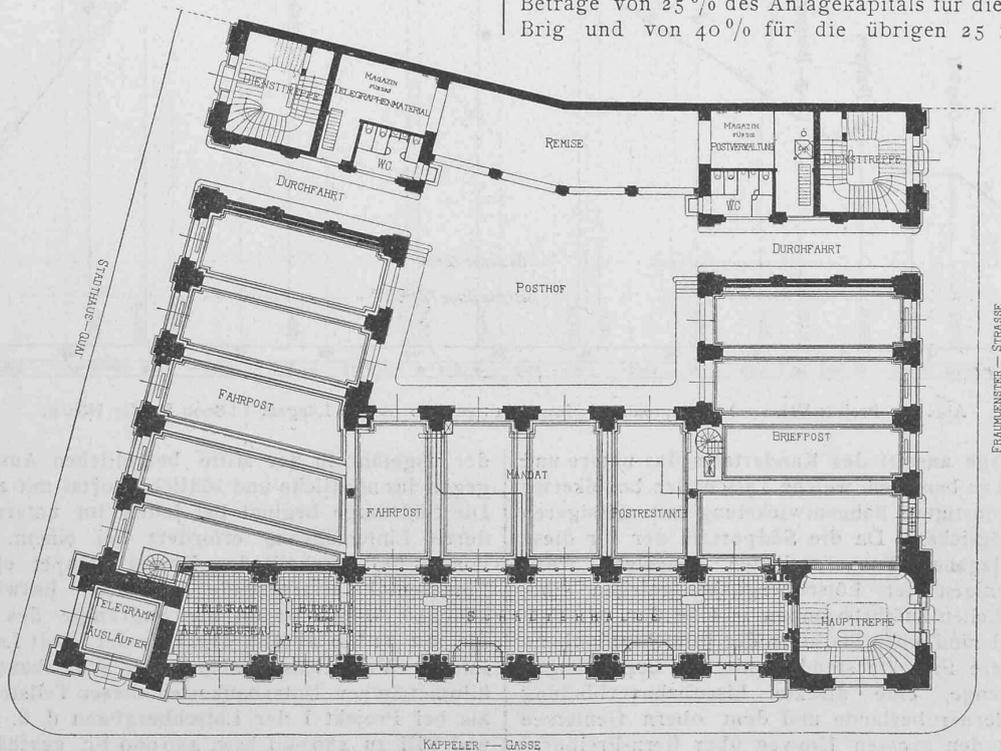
Grundriss vom Erdgeschoss. — Masstab 1 : 500.
